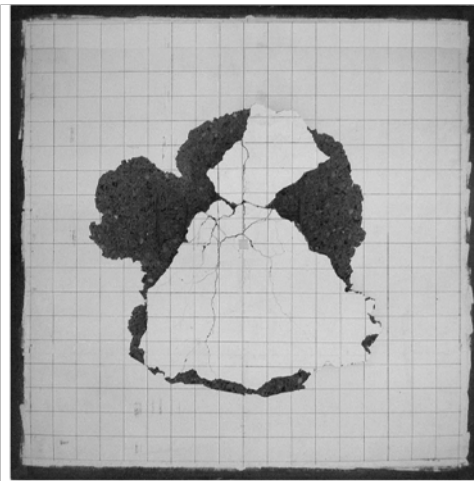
に実験終了後における RC 版裏面の破壊性状を示す。写真より、N 試験体の場合には、版中央部のコンクリートがほぼ円形状に押し抜かれ、かぶりコンクリートが部分的に剥落していることがわかる。SN-0 試験体の場合においても、N 試験体と同様、版中央部の吹付けコンクリートおよび RC 版のコンクリートがほぼ円形状に押し抜かれている。ただし、RC 版の押し抜きせん断ひび割れが吹付けコンクリート内部にも進展しているため、N 試験体よりも剥落範囲が大きく示されている。
